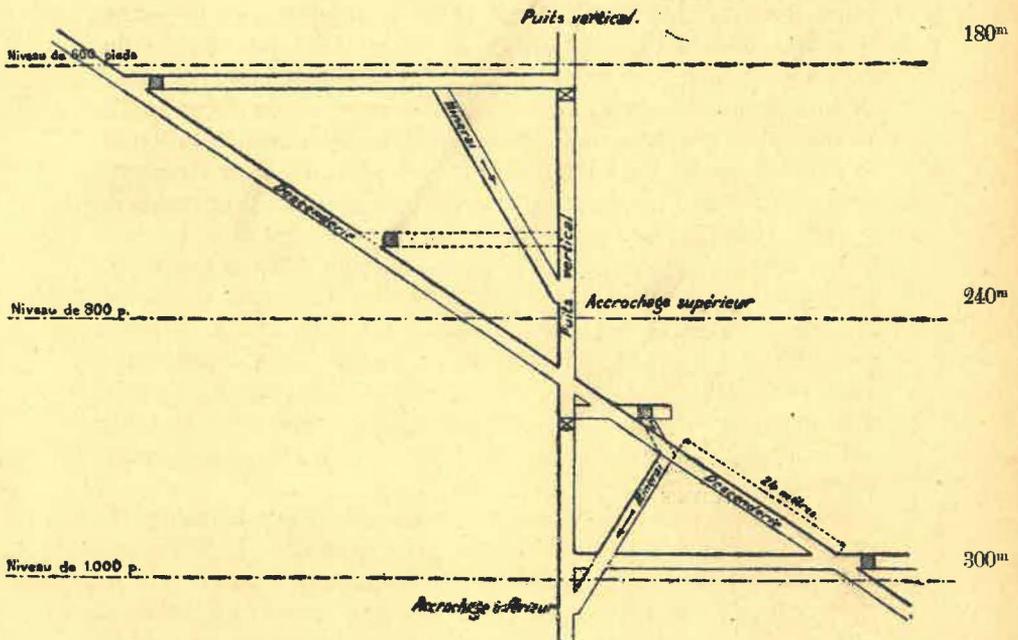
Coupe verticale suivant la ligne de la plus forte pente de la couche.
